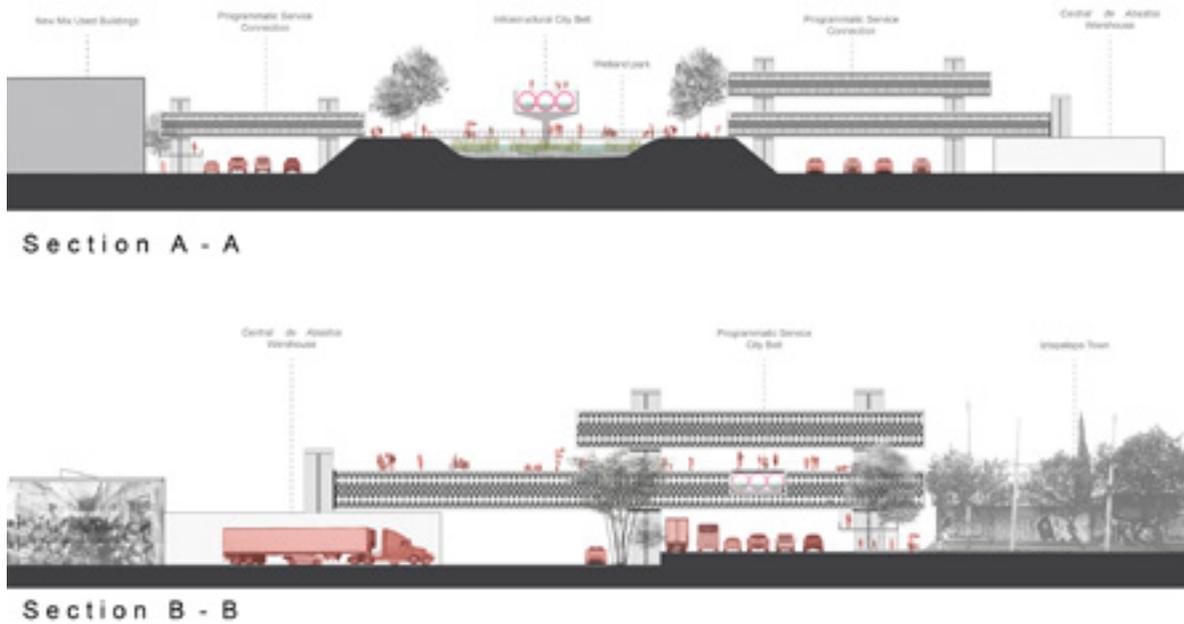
Secciones arquitectónicas del proyecto. Elaboración THU.
